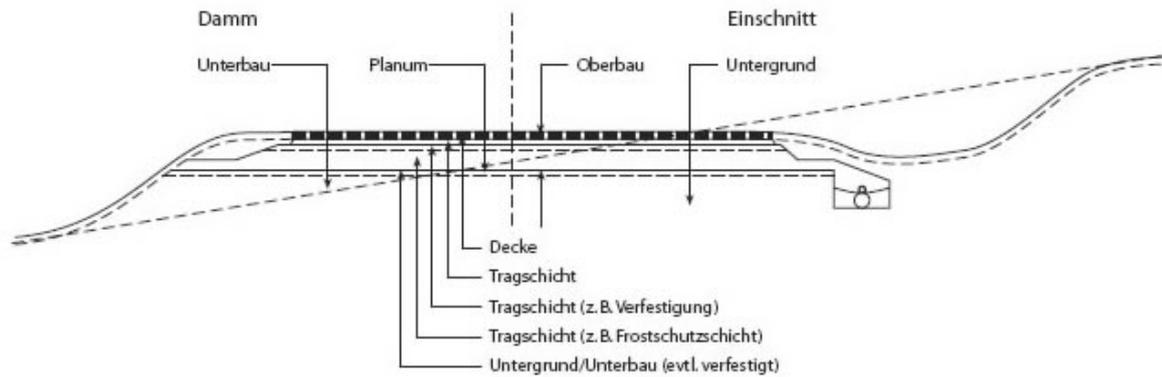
Beispielhafter Aufbau einer Befestigung mit Betondecke außerhalb geschlossener Ortslage im klassifizierten Straßenbau – Damm / Einschnitt¹⁵⁹
